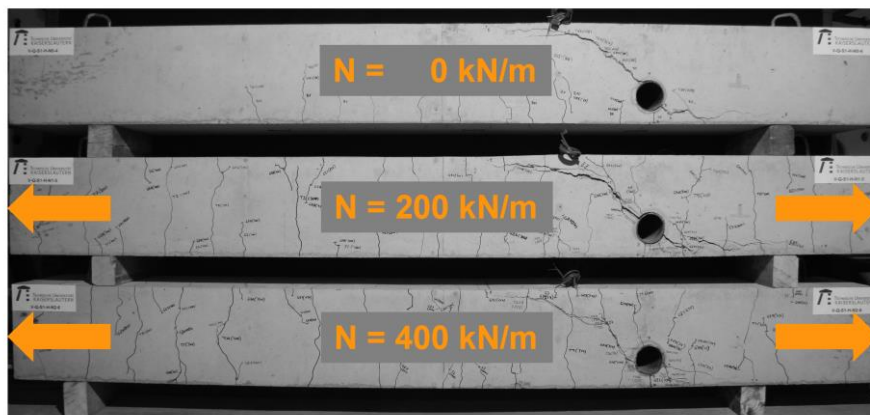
Schematische Darstellung der Längszugkräfte einer Versuchsserie an Stahlbetonplattenstreifen mit integrierten Hohlräumen.
